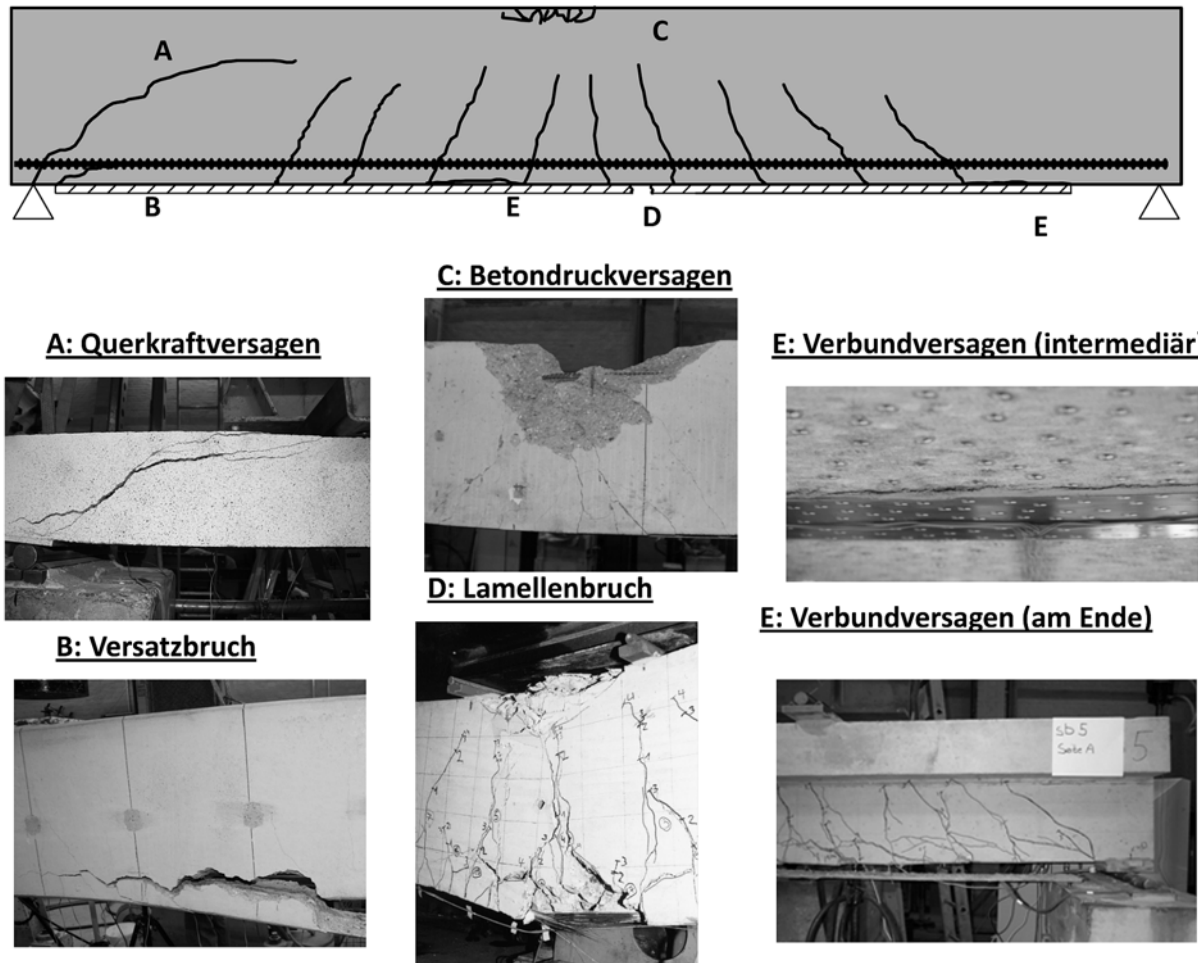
Exemplarische Darstellung der auftretenden Versagensarten eines durch geklebte Bewehrung biegeverstärkten Stahlbetonträgers
